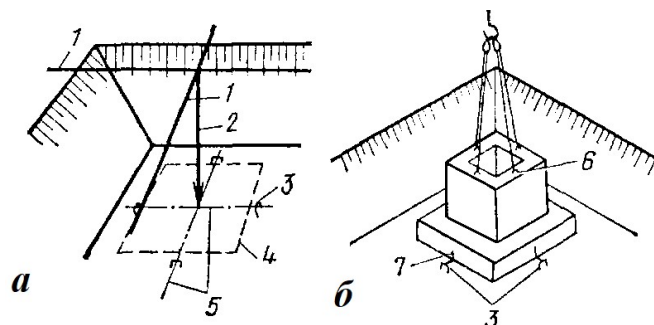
Монтаж фундаментів під колони: а – розбивка під монтаж; б – схема монтажу; 1 – осі будинку; 2 – схил; 3 – розбивочні скоби або кілочки; 4 – контури основи фундаменту; 5 – осьові лінії фундаментів; 6 – риски на верхній поверхні фундаменту; 7 – риски на бічних гранях подушки блоку
